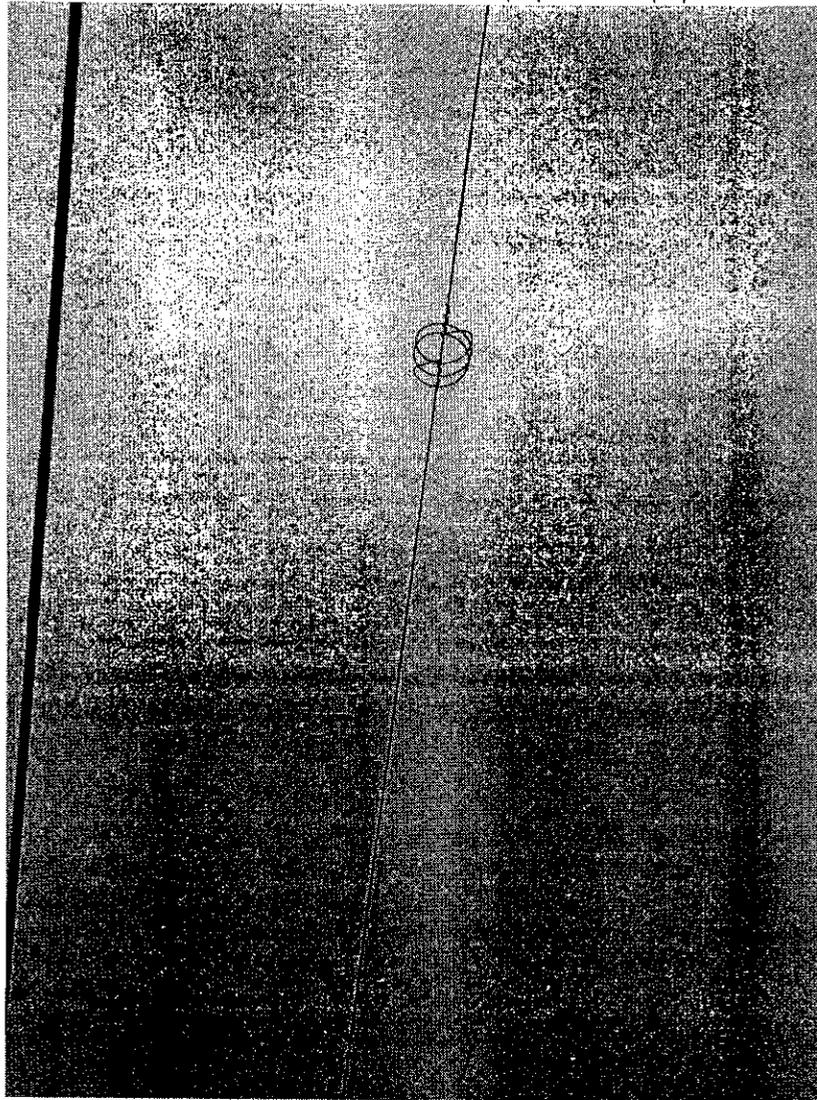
Salva pájaros en tramo Apoyo N°43- Apoyo N°44
